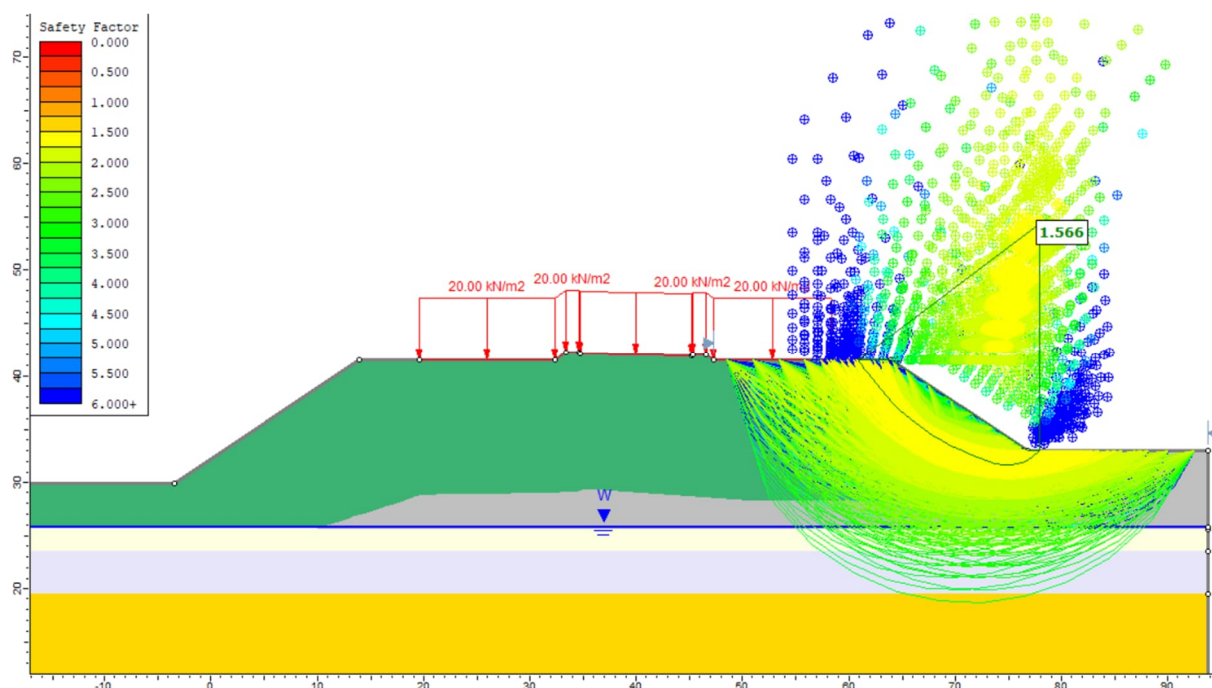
Analisi statica – Sponda DX – Rilevato di varo – Lato valle - FS=1,566
